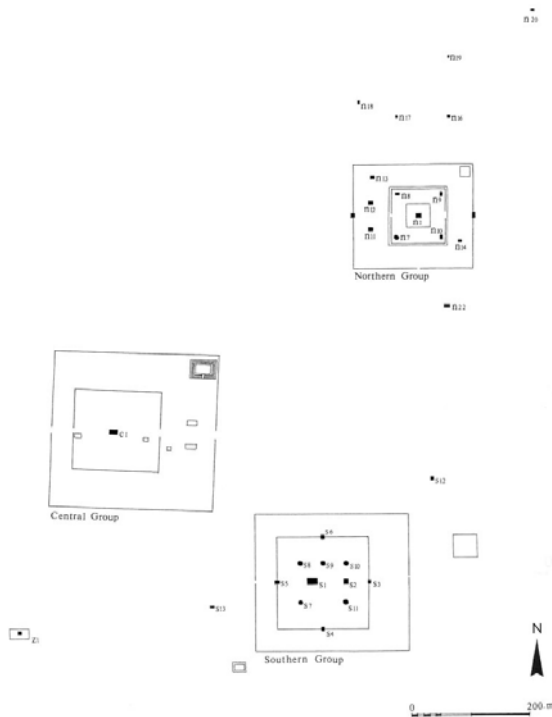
Lageplan Isanapura (Sambor Prei Kuk)
